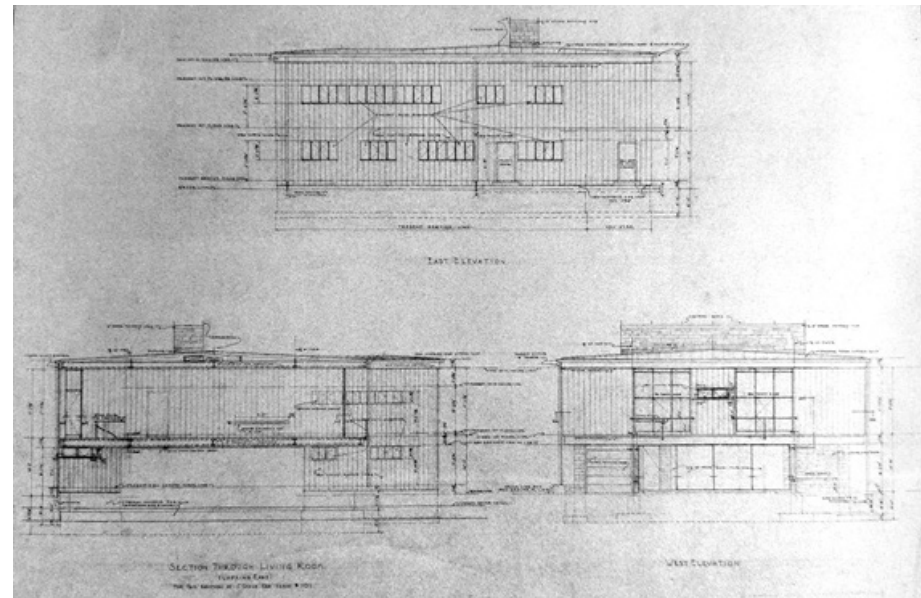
Alzados este y oeste y sección del proyecto definitivo de la Resor House
